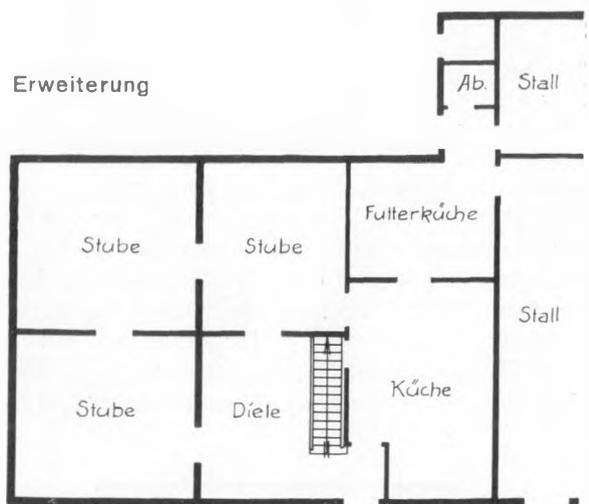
Dasselbe Wohnhaus nach erfolgtem Anbau von 2 Wohnräumen im Erdgeschoß. Zwei weitere Giebelzimmer können im Dachgeschoß ausgebaut werden.
